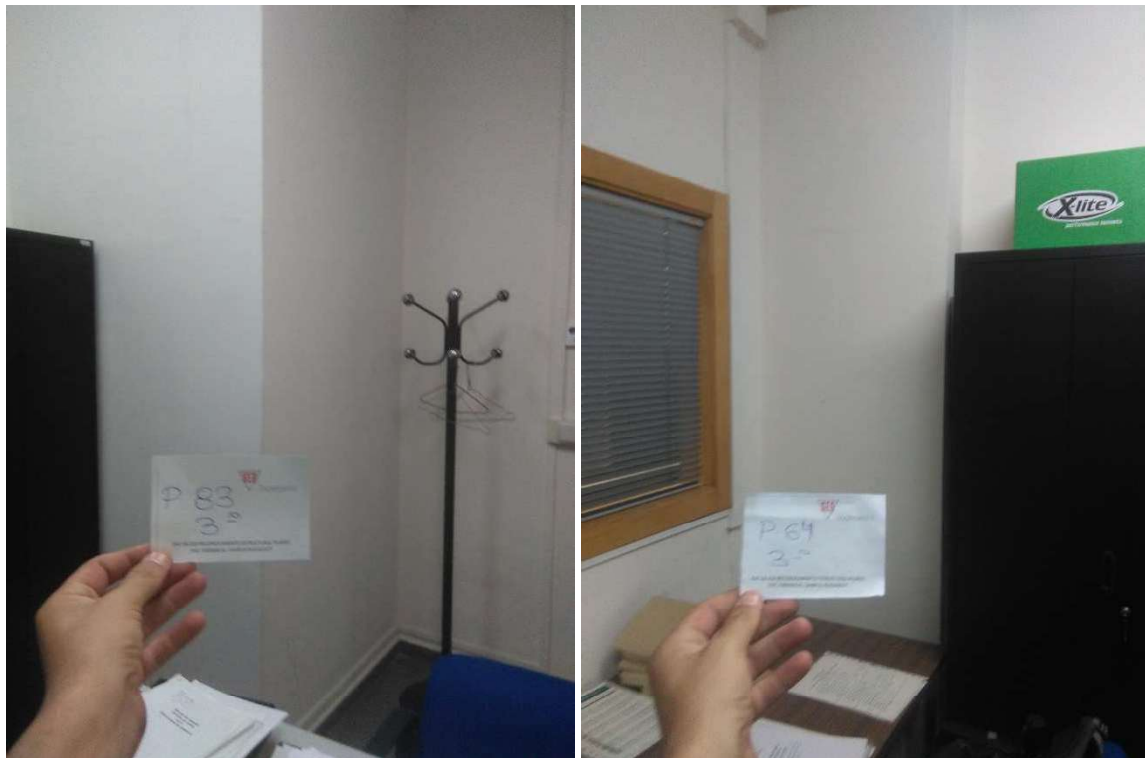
y 40. Vista generales de pilares 84 y 83 en entresuelo
